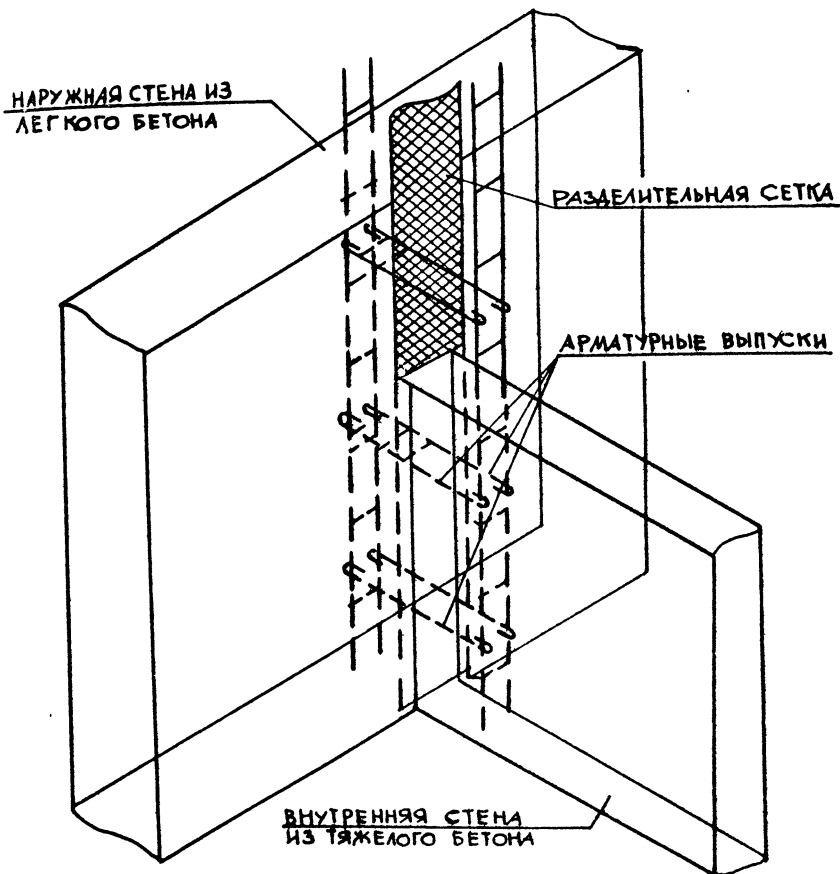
а. Бесположные контактные вертикальные стыковые соединения монолитных стен из бетонов разных видов, бетонируемых в едином технологическом цикле
